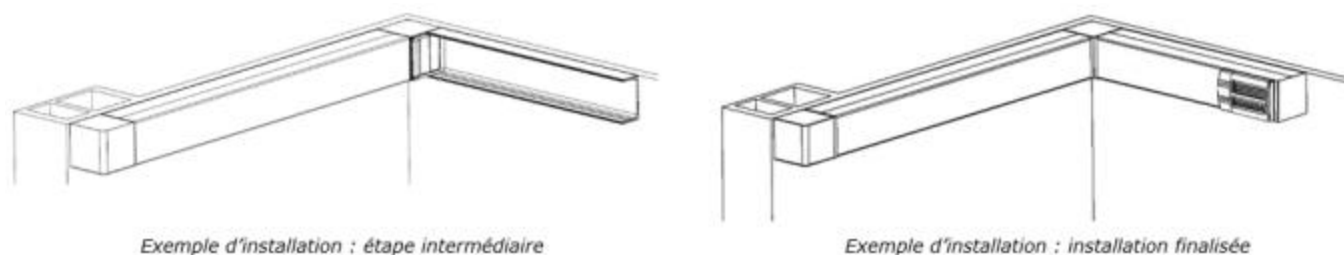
Exemples de mise en œuvre des conduits horizontaux JOK'AIR
